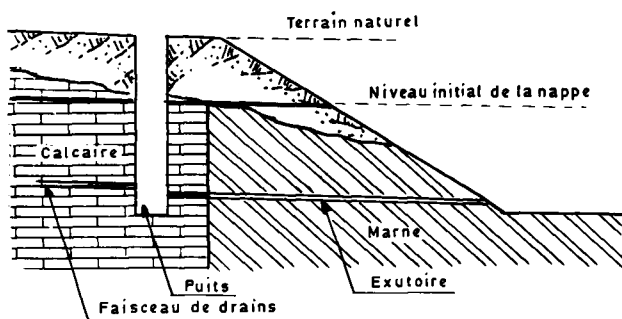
Puits et drains subhorizontaux (autoroute A6, tranchée de Lasalle, Saône-et-Loire).
